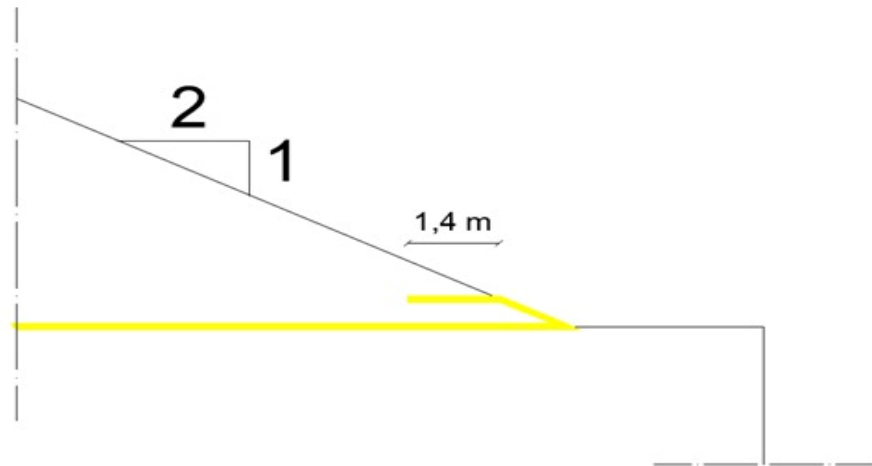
Detail Panjang *Overlapping* Geotekstil Pada Timbunan 12m
